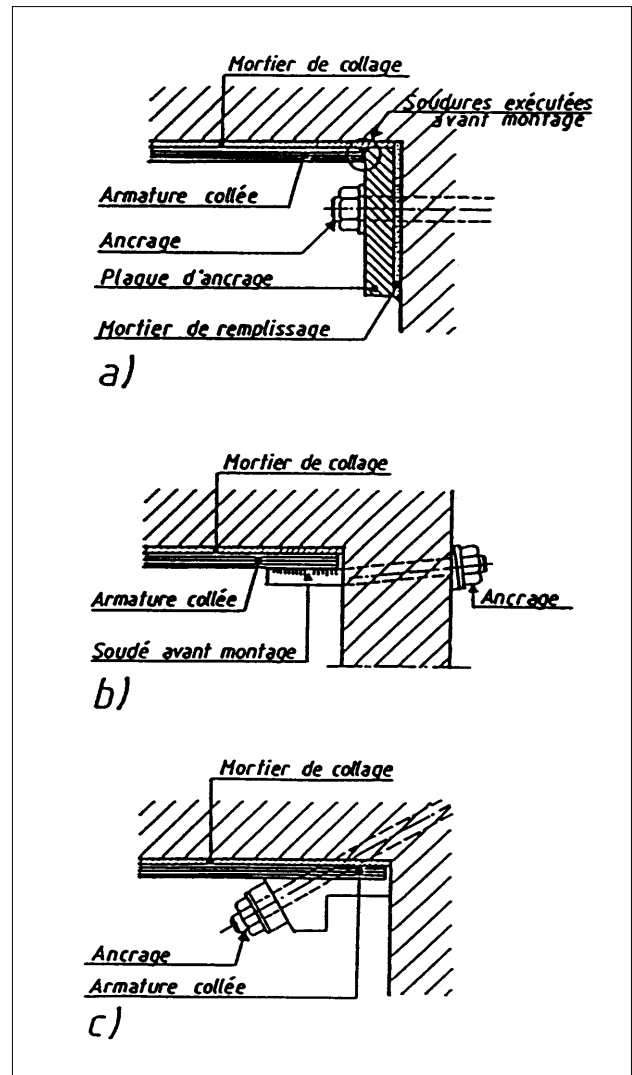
Ancrages des lames: exemples de dispositifs de sécurité.
